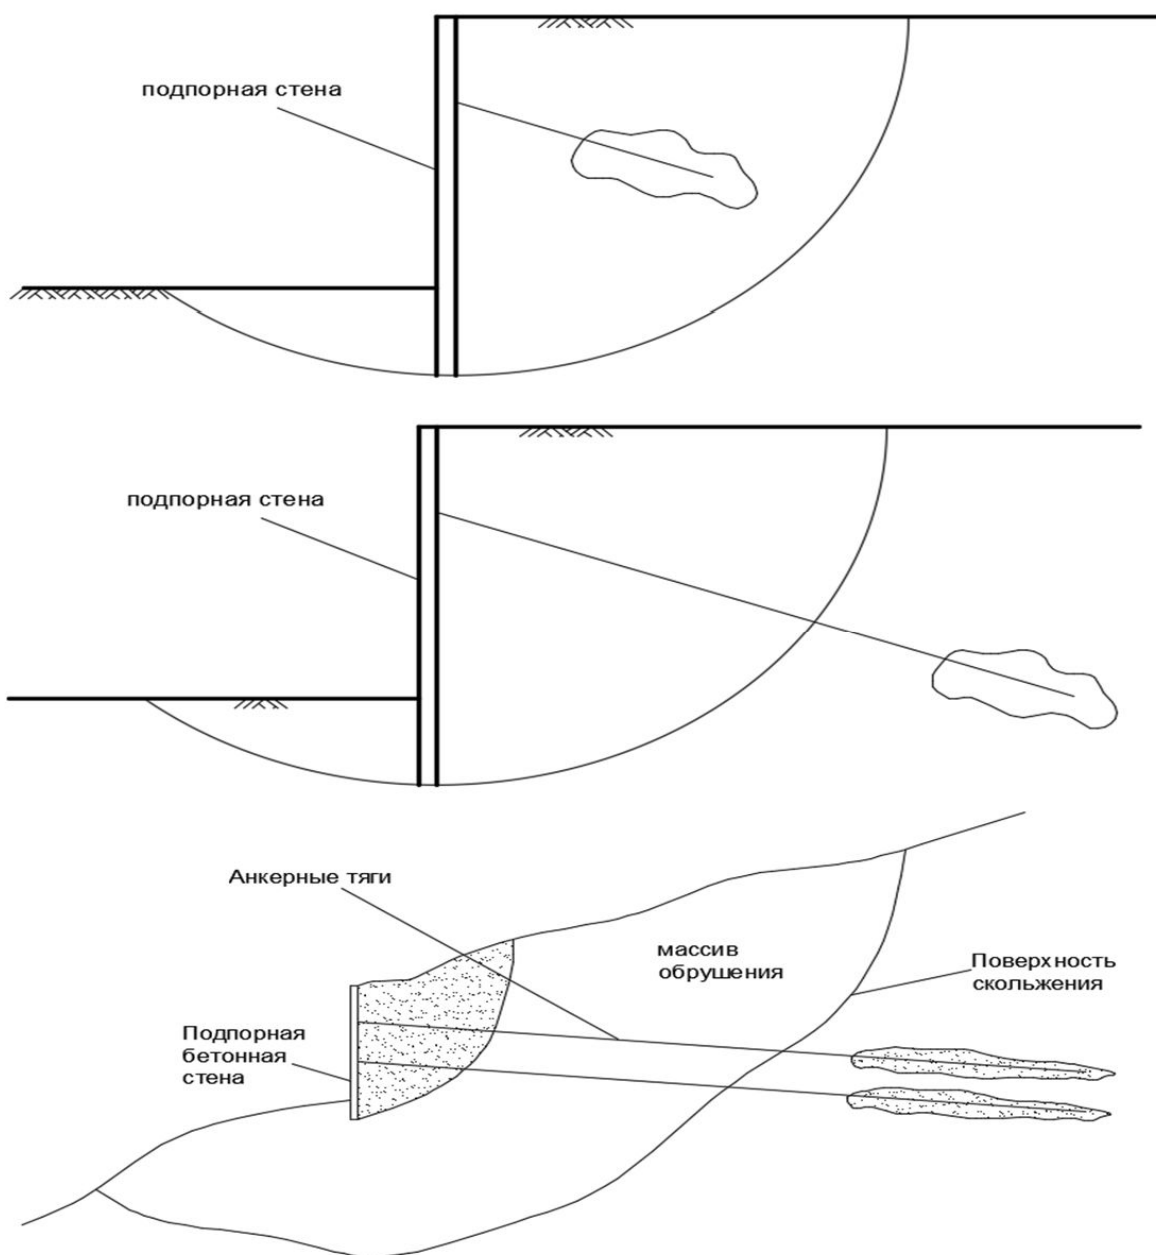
Бетонные подпорные стенки с анкерными тягами
